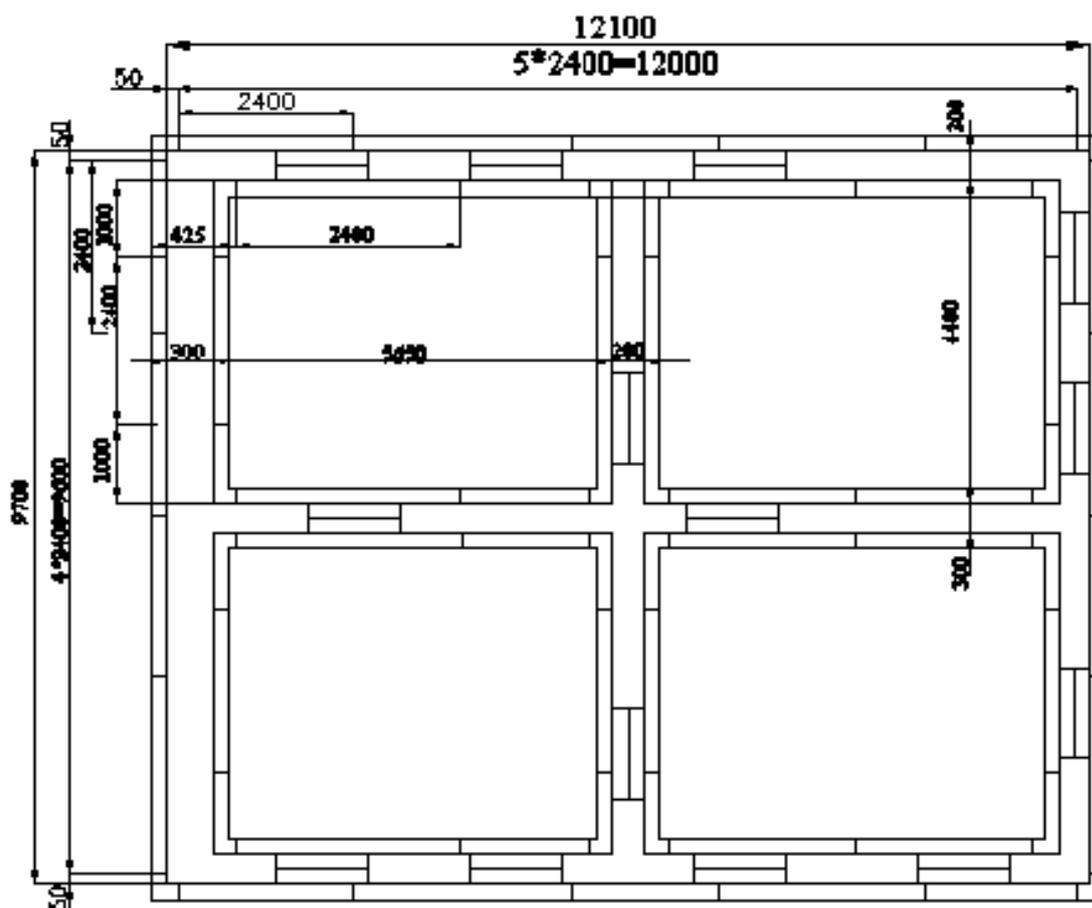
План типового одноэтажные здания из монолитного золобетона
